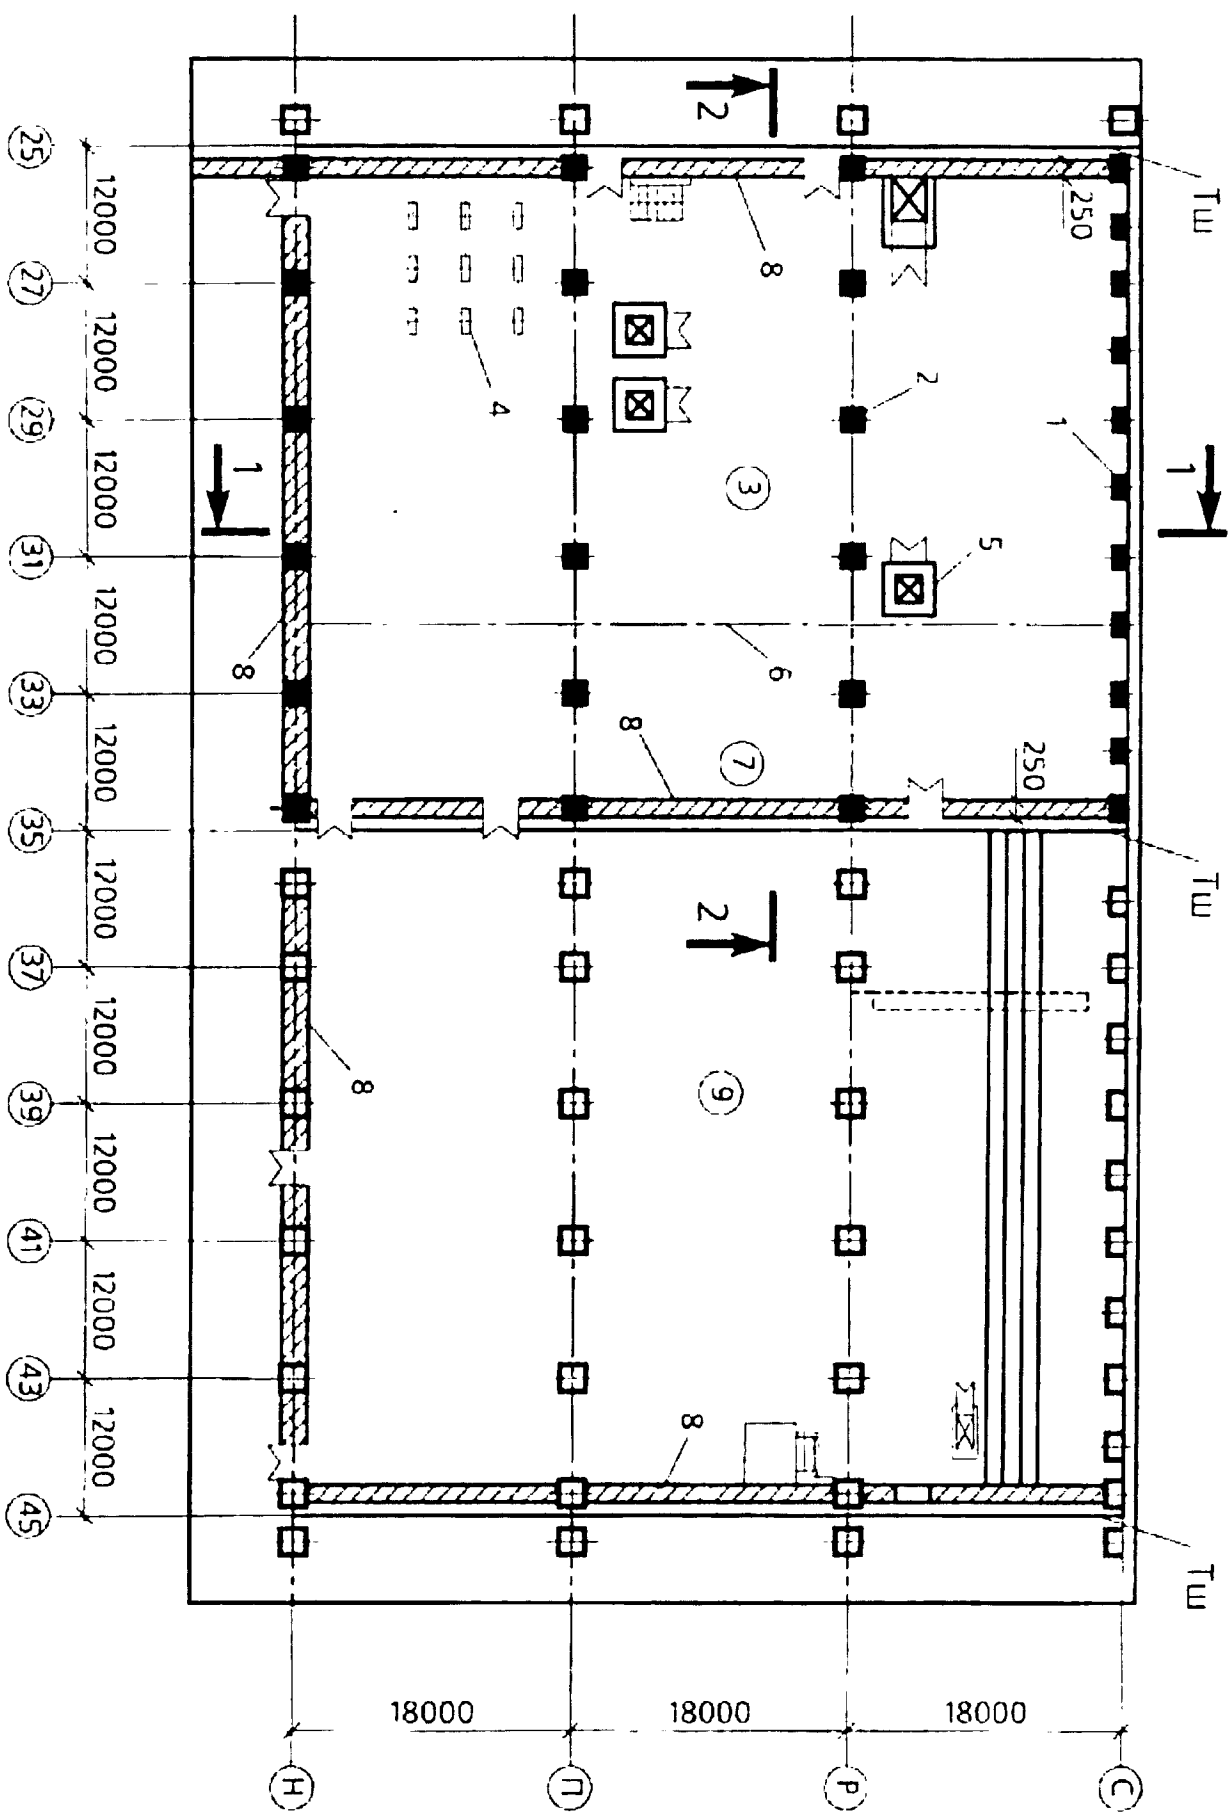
Главный корпус завода пластмасс (план на отметке +4,8 м): 1 - колонны К-1 двухъярусные крайние железобетонные (шаг 6 м); 2 - колонны К-2 средние железобетонные (шаг 12 м) несущего каркаса; 3 - склад готовой продукции; 4 - стойки циклонов металлические; 5 - пакеты подвешенные; 6 - металлическая сетчатая перегородка; 7 - склад сырья; 8 - противожарные экраны; 9 - цех производства жидких диоксида углерода; Тш - температурный щит
